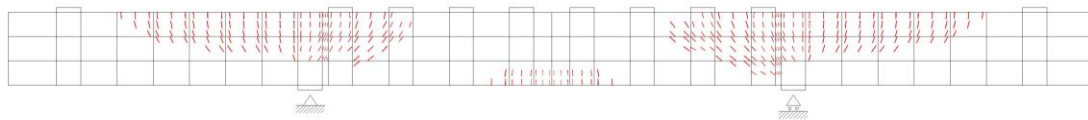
破壊時の変形及びひび割れ状態 (Case No. 13)
